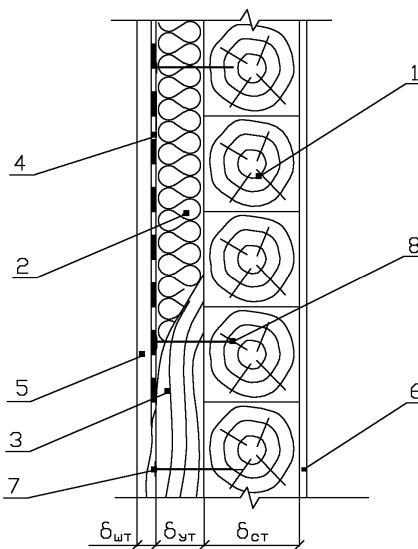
Утепление стены из бруса плитами ИЗОРОК в конструкции со штукатурным покрытием по несущей металлической сетке.
